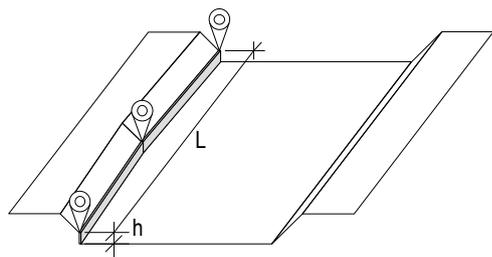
Schéma d'un mur de rive, ouvrage longitudinal.
